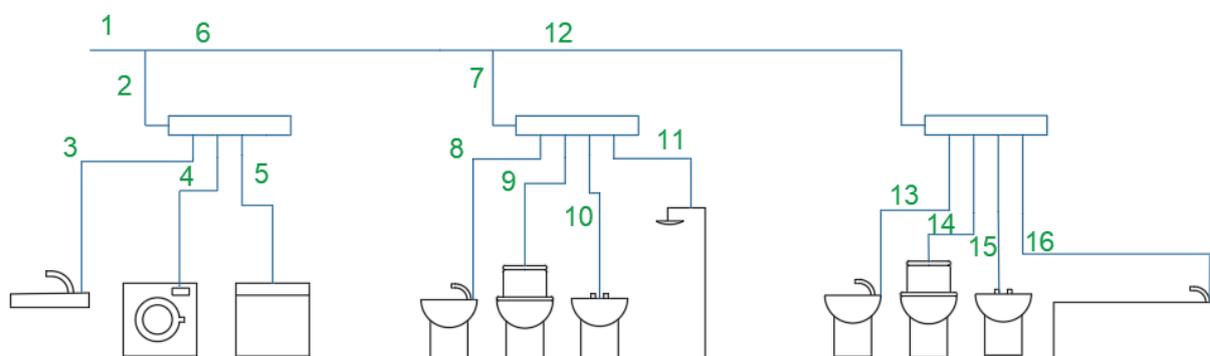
Esquema de instalación. Fuente: elaboración propia
